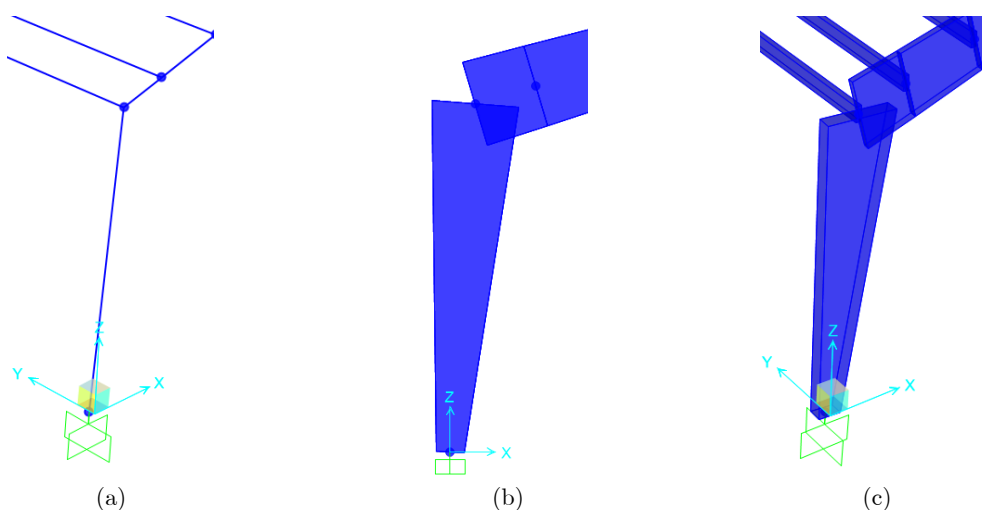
Pormenor de modelação do pilar: a) representação do eixo do pilar; b) representação plana do pilar evidenciando as principais dimensões; c) vista 3D incluindo as dimensões do pilar.
